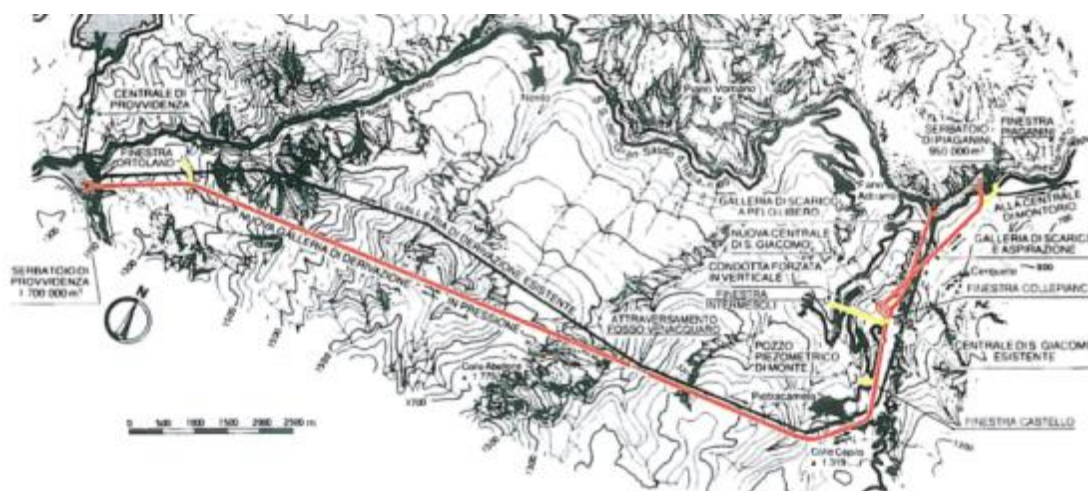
Impianto di San Giacomo – schema idraulico planimetrico
